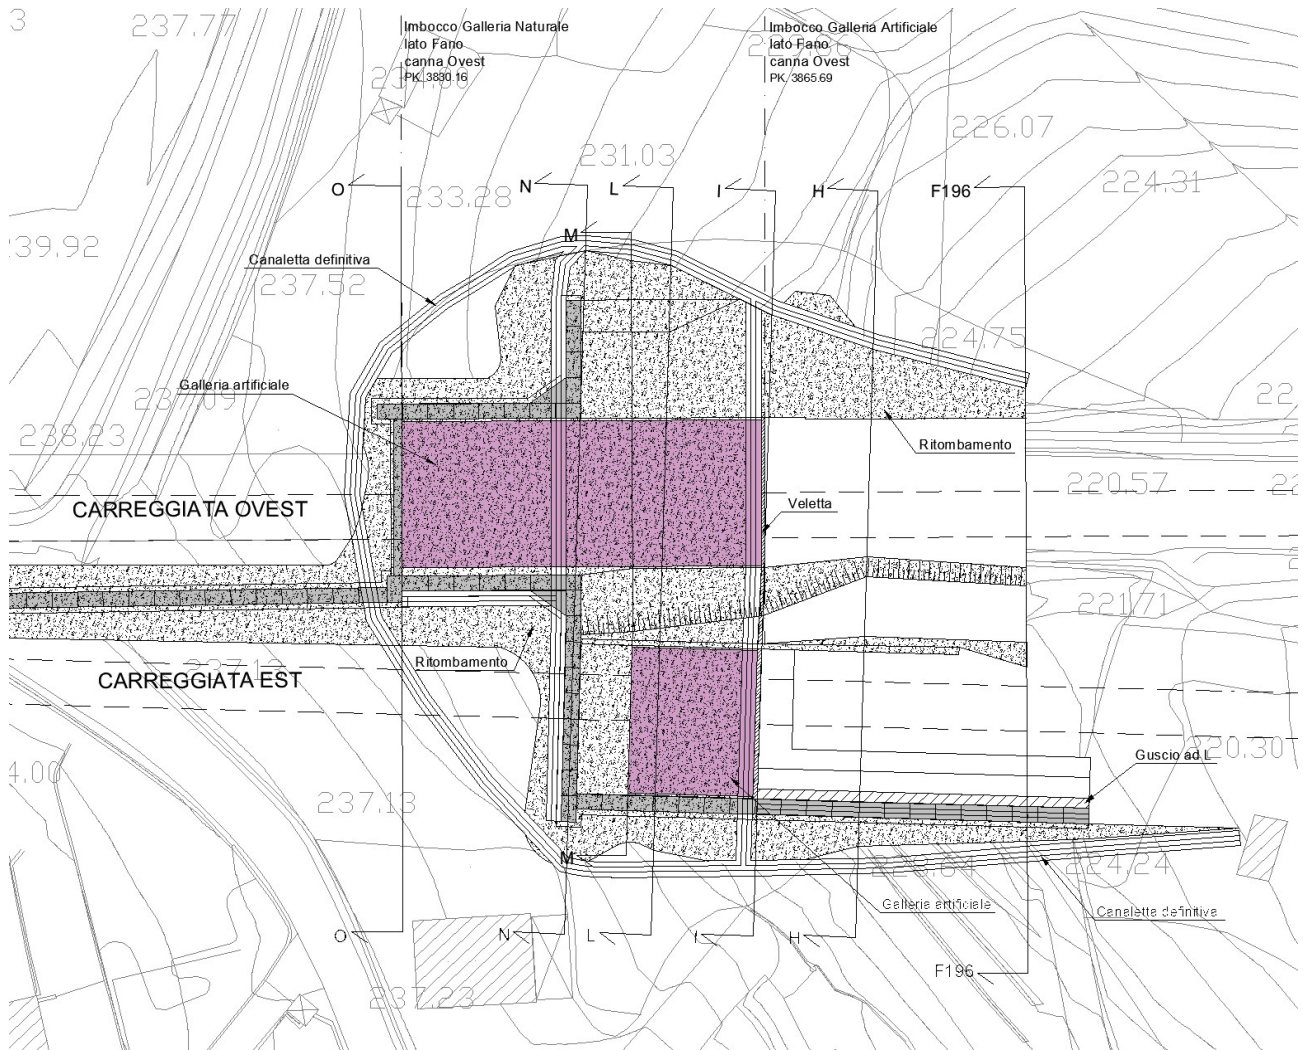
Planimetria galleria artificiale Bucciano – Imbocco Lato Fano
